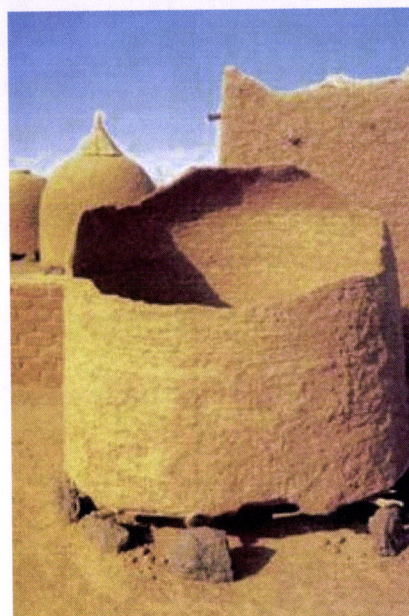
CAMARÕES – Vista de um silo semi-construído¹⁰
